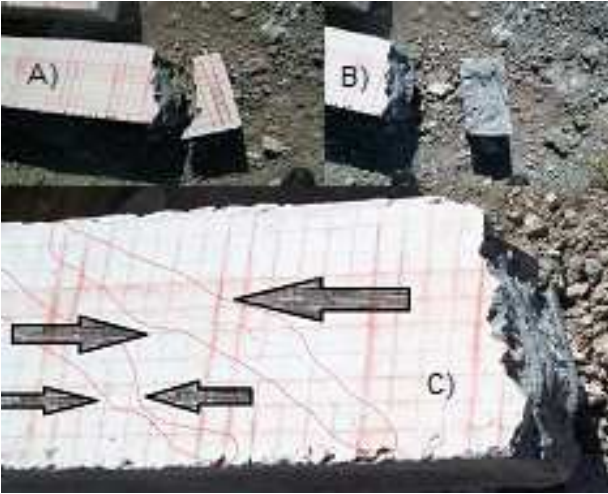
Patrón de grietas de la viga CRM1.
